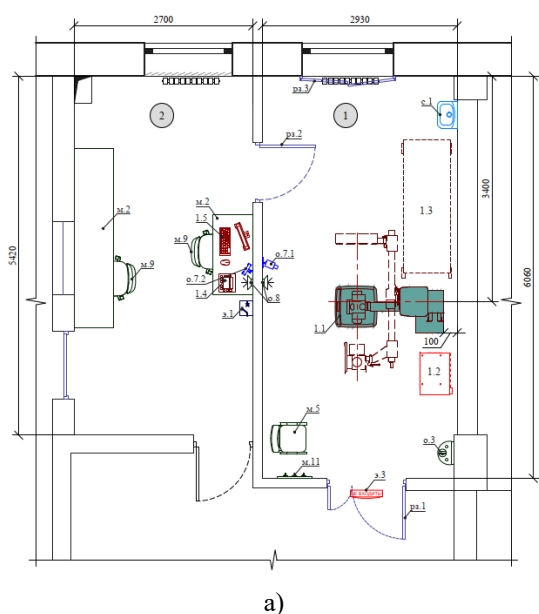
Фрагмент плана БТИ с изображением помещений на этаже
